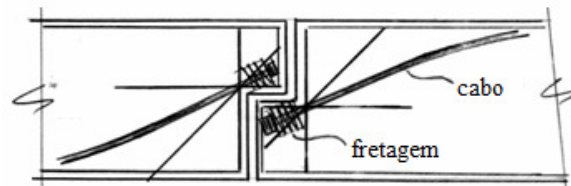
Esquema de uso de armaduras em dentes Gerber simples de concreto protendido.
